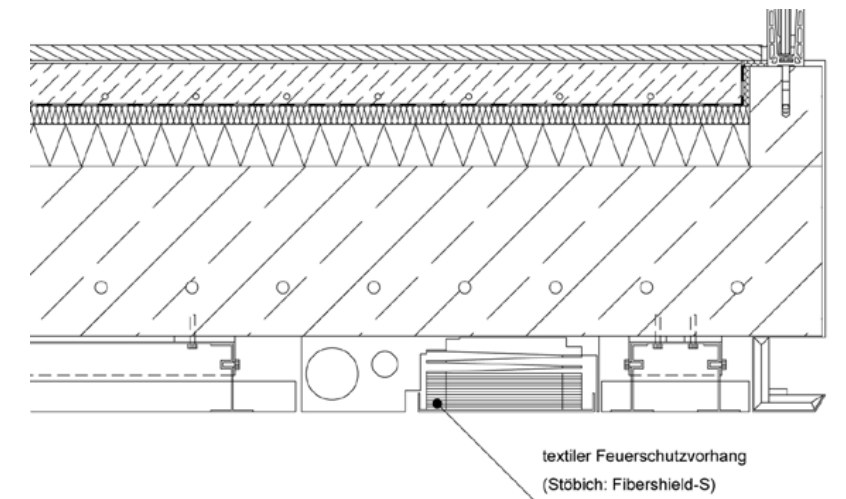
Eigenes Konstruktionsdetail - textiler Feuerschutzvorhang bei Atrium
